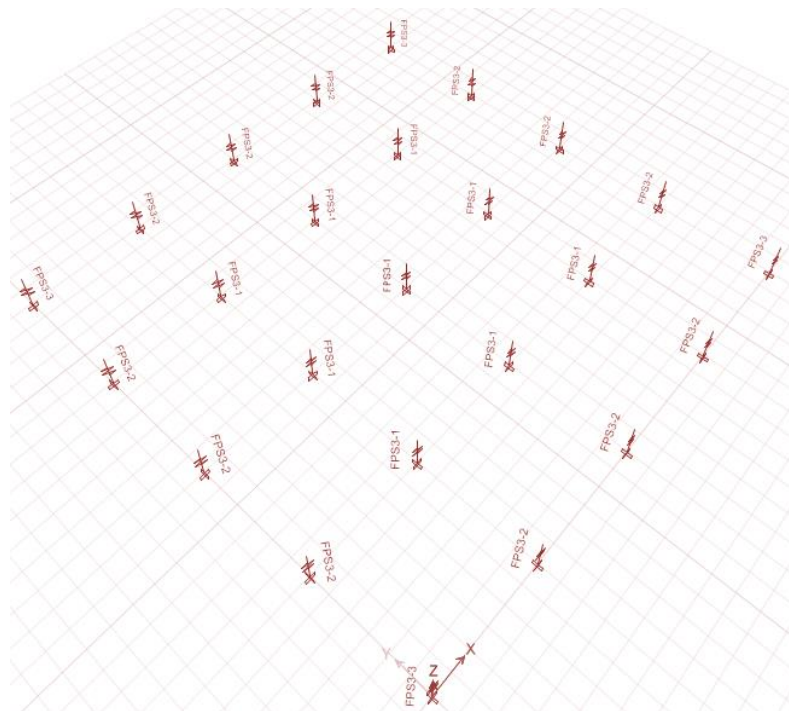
Distribución en Planta Aisladores tipo TFP (Microzona Piedemonte C). Fuente: Propia.
